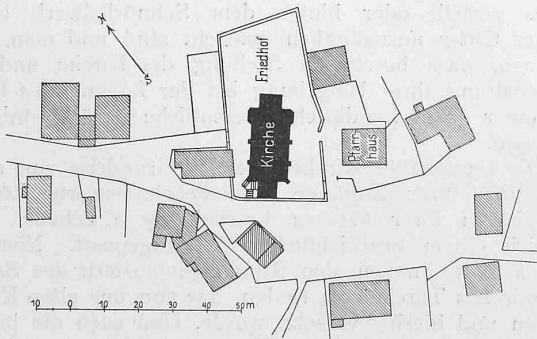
Lageplan der Kirche. — Masstab 1 : 1500.
